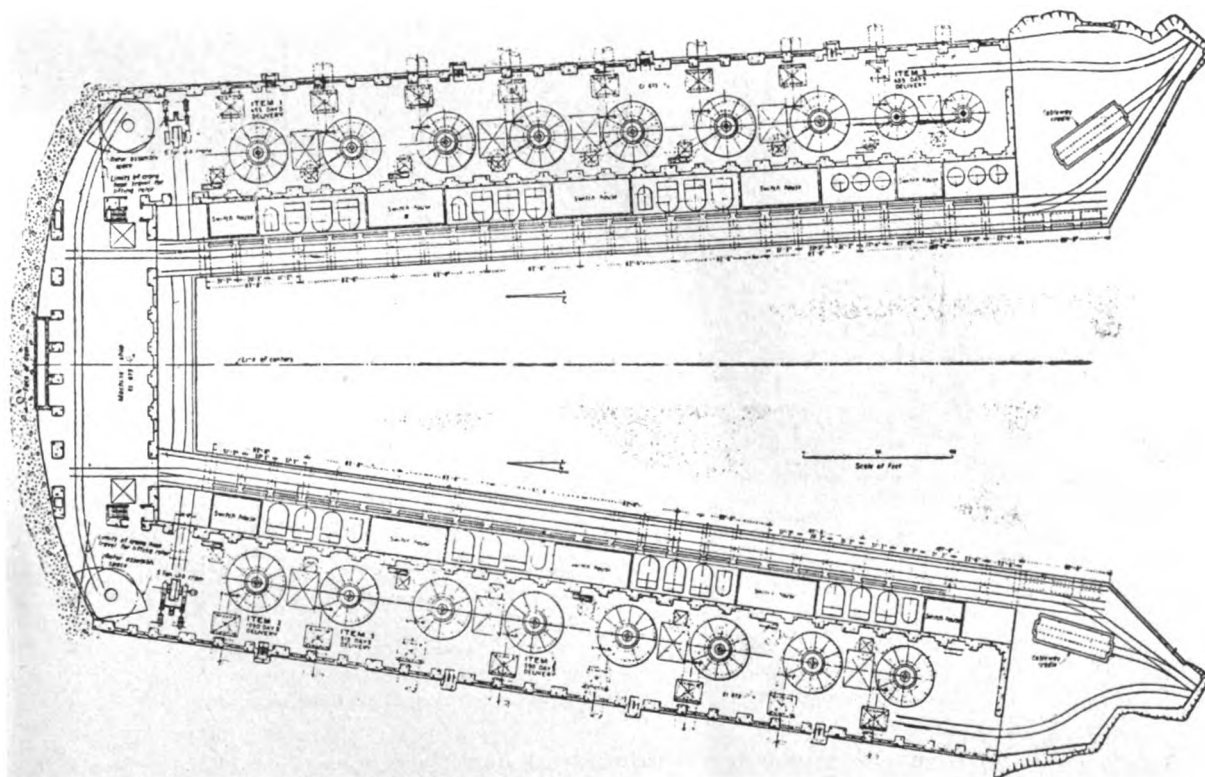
Pianta della centrale idroelettrica di Boulder Dam.
